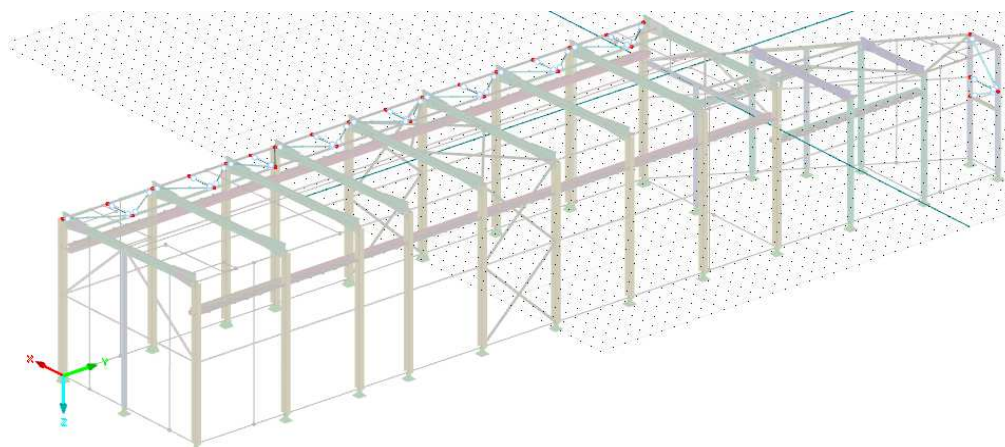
Geometrie konstrukce - RO168,3x5
